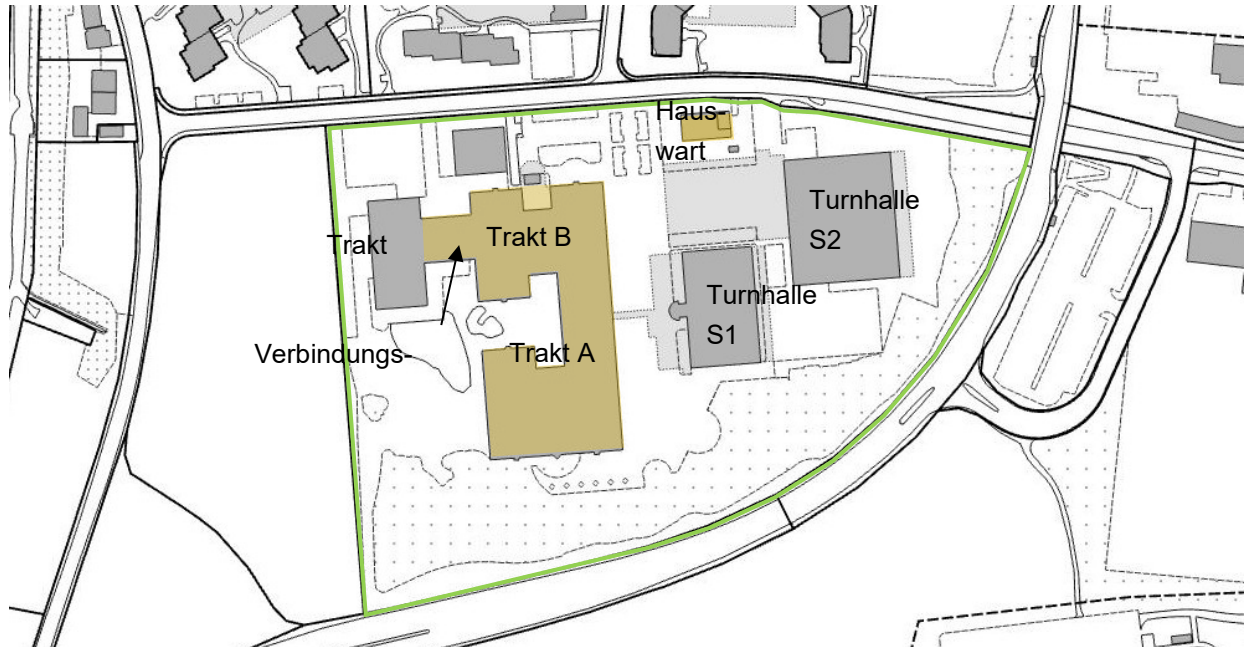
Projektperimeter Gebäudehülle (+Haustechnik Trakt A&B)
